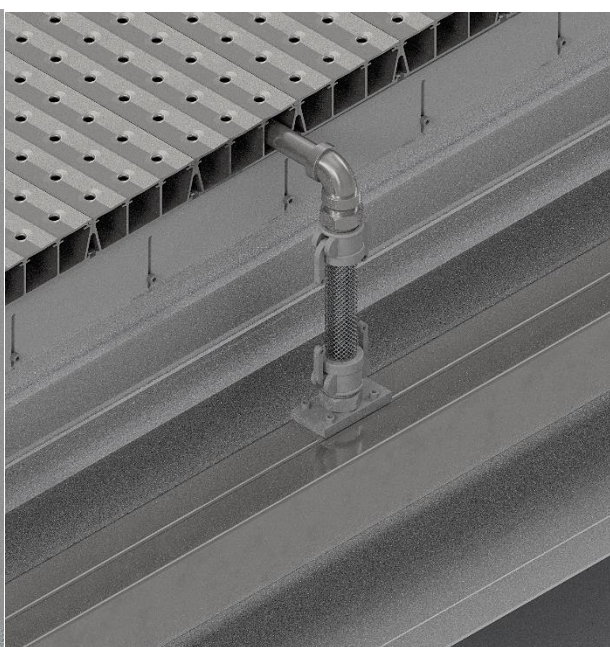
Conexión de la tubería enterrada al suministro del distribuidor de lavado
